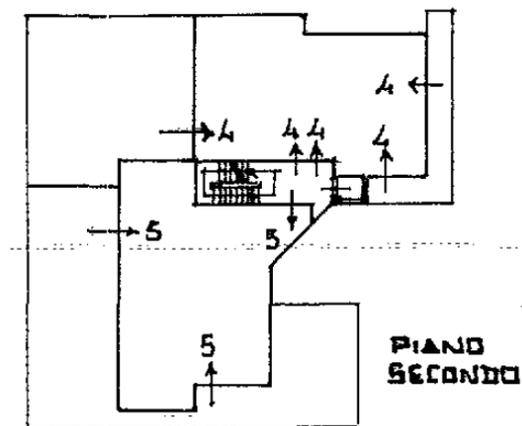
Estratto dell’elaborato planimetrico – piano secondo
